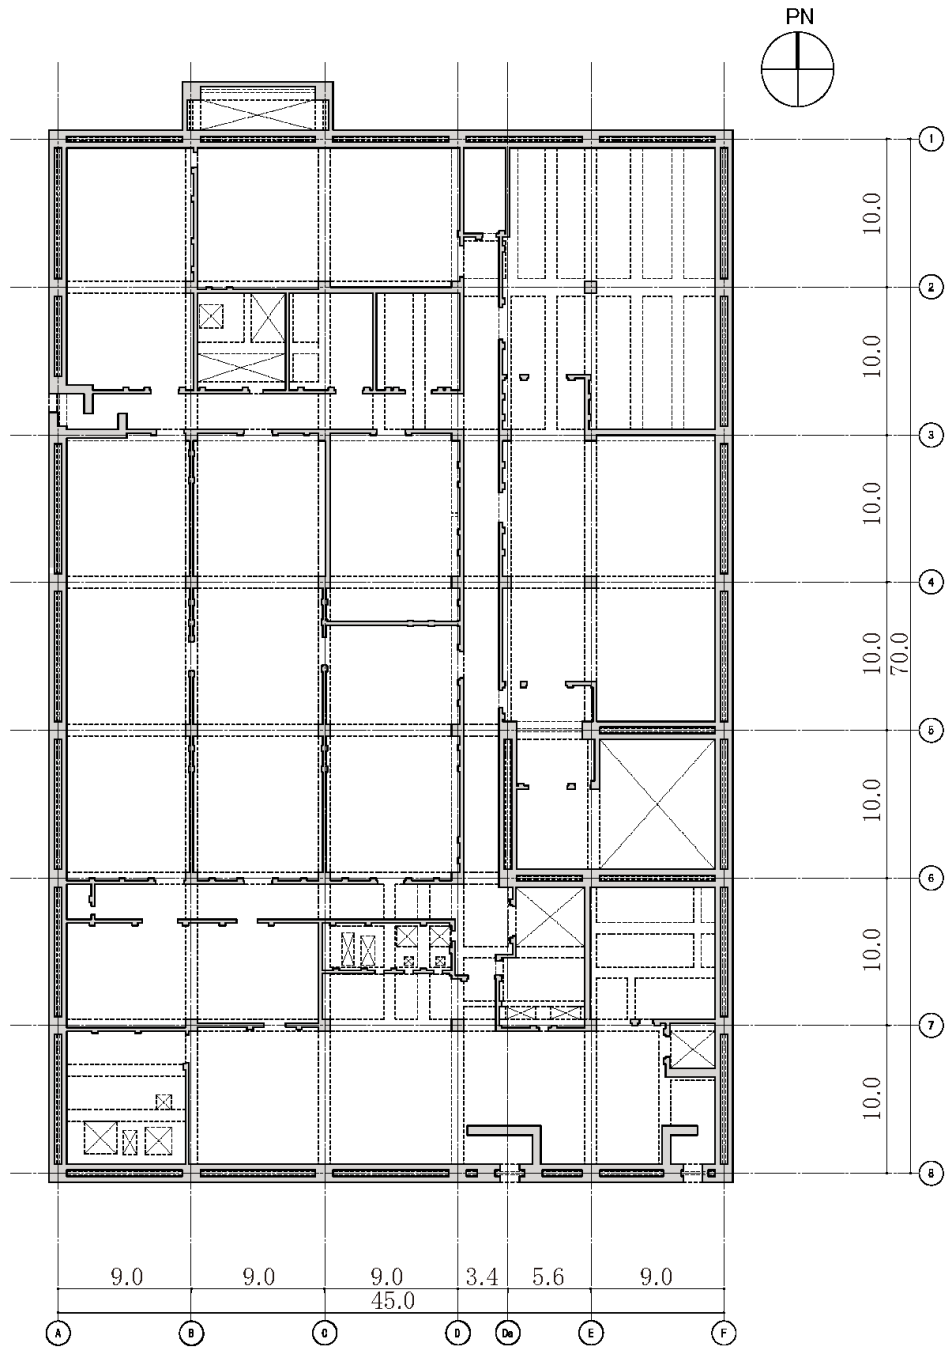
2階平面図 (G.L. +8.80) (単位 : m)
